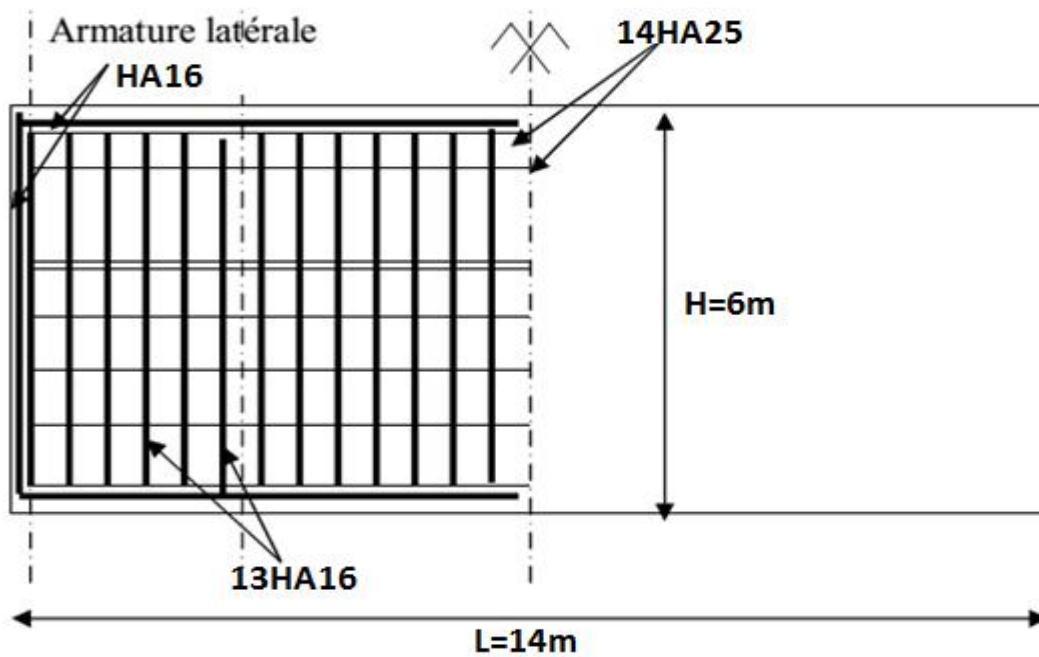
Ferrailage de la semelle (nappe supérieure).
